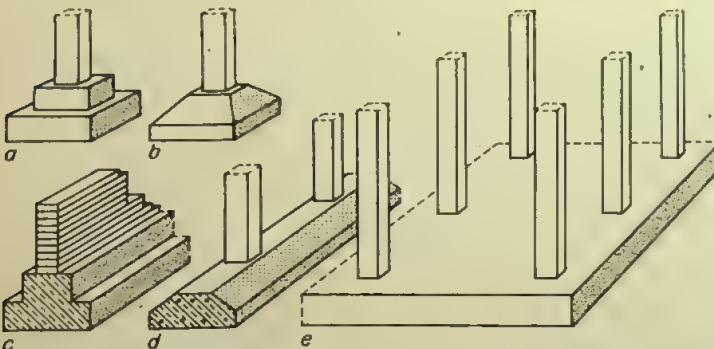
Flachgründungen: a Einzelfundament aus Stampfbeton und b aus Stahlbeton, c Streifenfundament unter einer Wand und d unter einer Stützenreihe, e Ausschnitt aus einer Fundamentplatte
